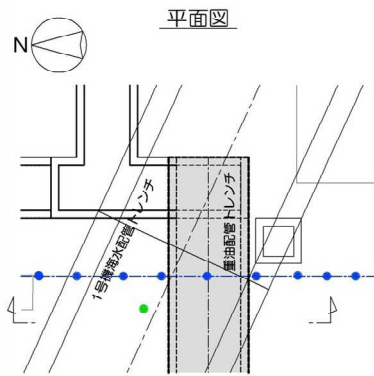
【12-10】1号機取水電源ケーブル管路 施工方法（貫通施工）
